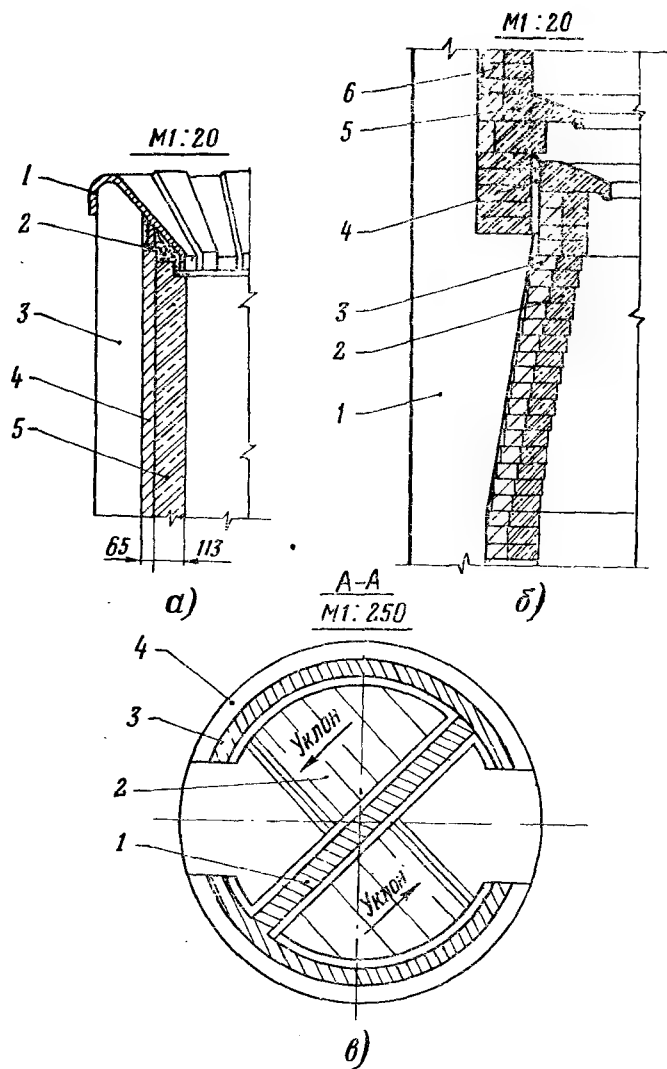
Элементы железобетонной дымовой трубы. $H=250$ м. а — верхняя часть: 1 — чугунный коляк; 2 — асбестовая крошка с глиной; 3 — ствол трубы; 4 — теплоизоляция; 5 — футеровка, б — средняя часть; 1 — ствол трубы; 2 — кислотоупорный кирпич; 3 — красный кирпич; 4 — асбестовый шнур; 5 — слезниковый кирпич; 6 — антикоррозийная защита. в — нижняя часть. 1 — перегородка; 2 — пандус; 3 — футеровка; 4 — ствол трубы
